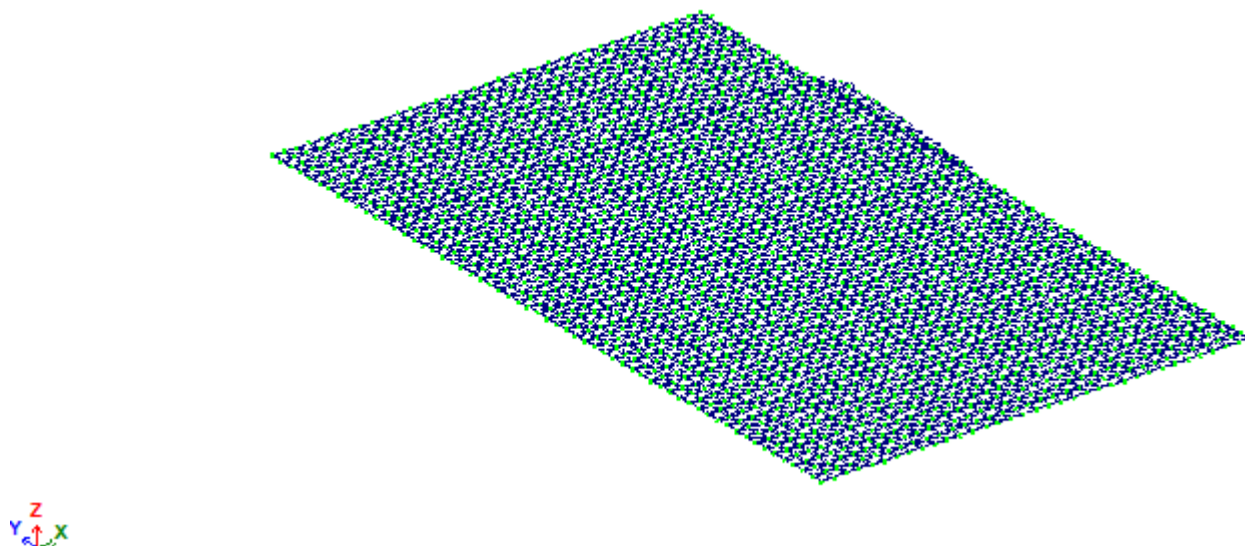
Розрахункова схема плити перекриття, побудована в програмі «ЛИРА-САПР»
